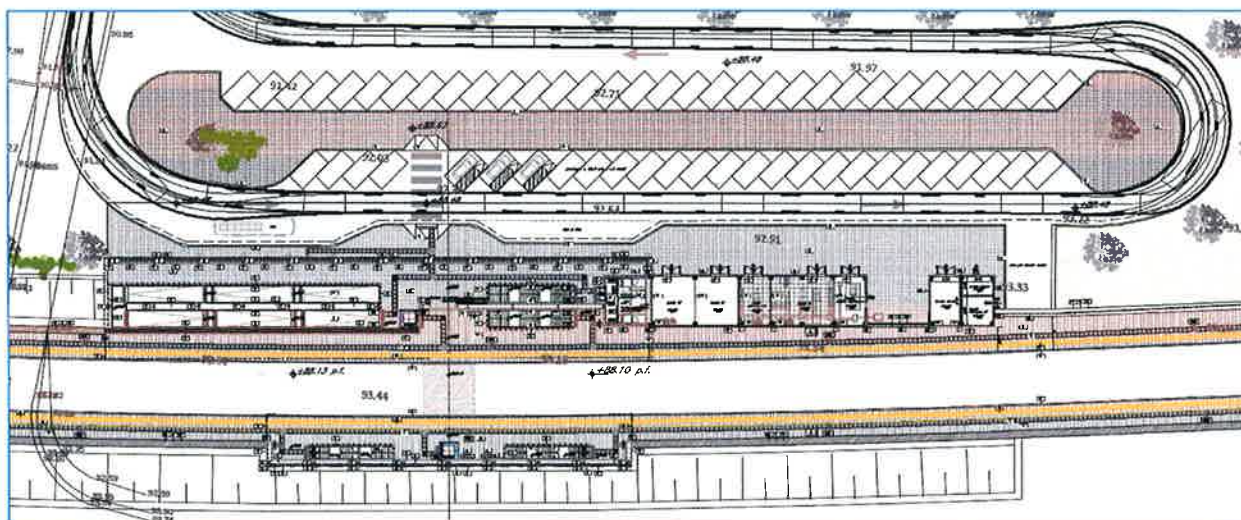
Fermata Ponte Casalduni – Planimetria piazzale (Rif. [49])
